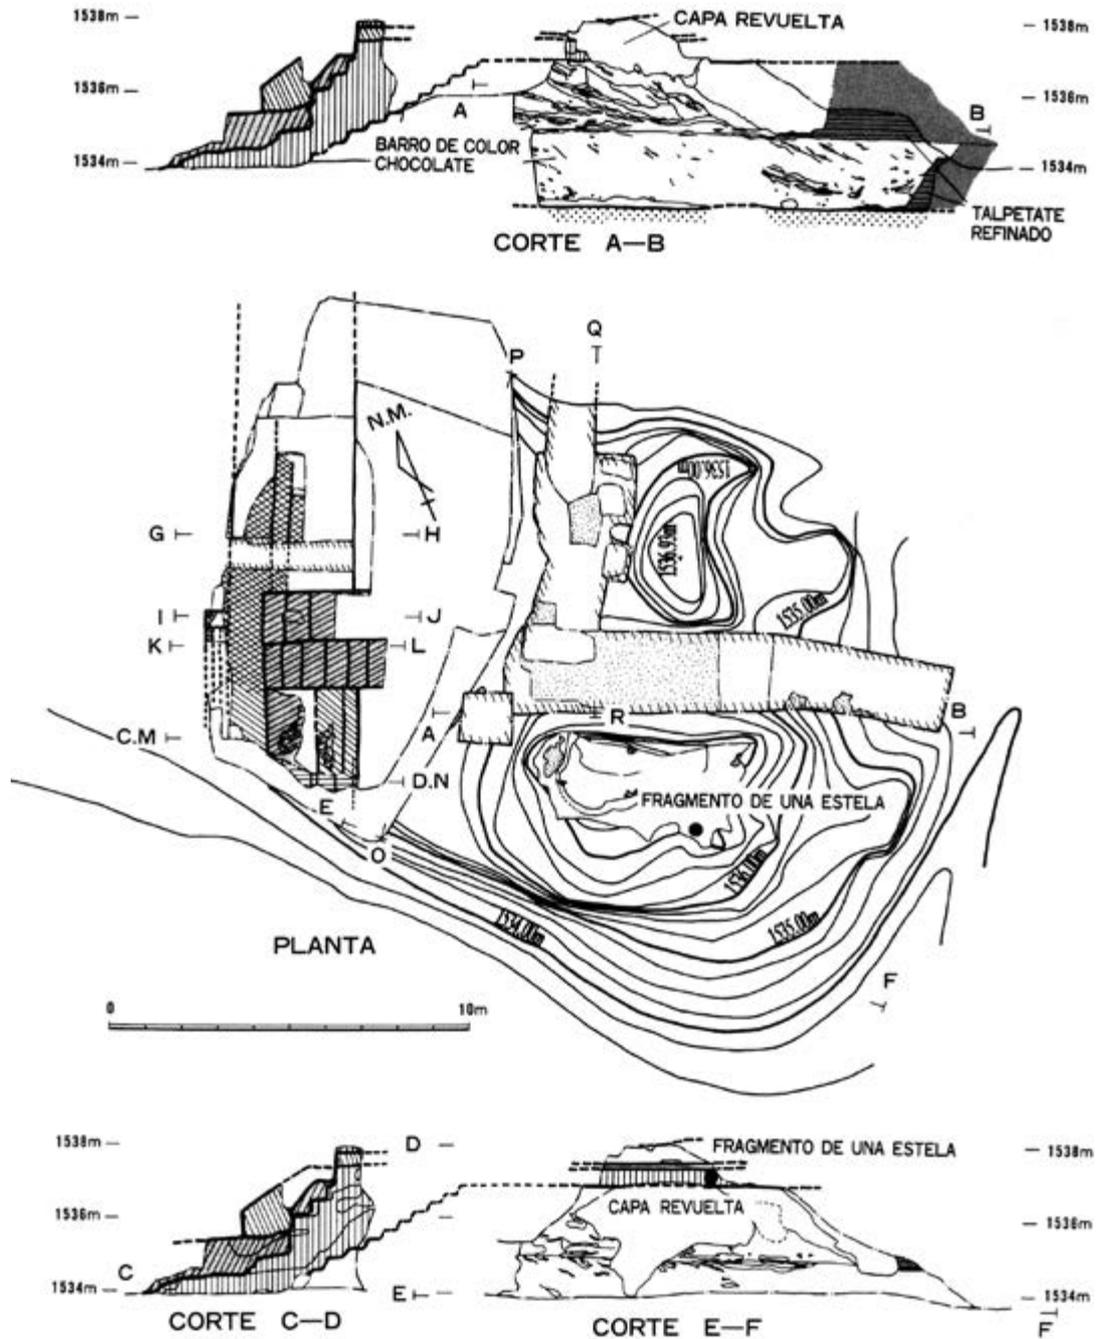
Planta y perfiles con el sistema constructivo del Edificio Chay.
